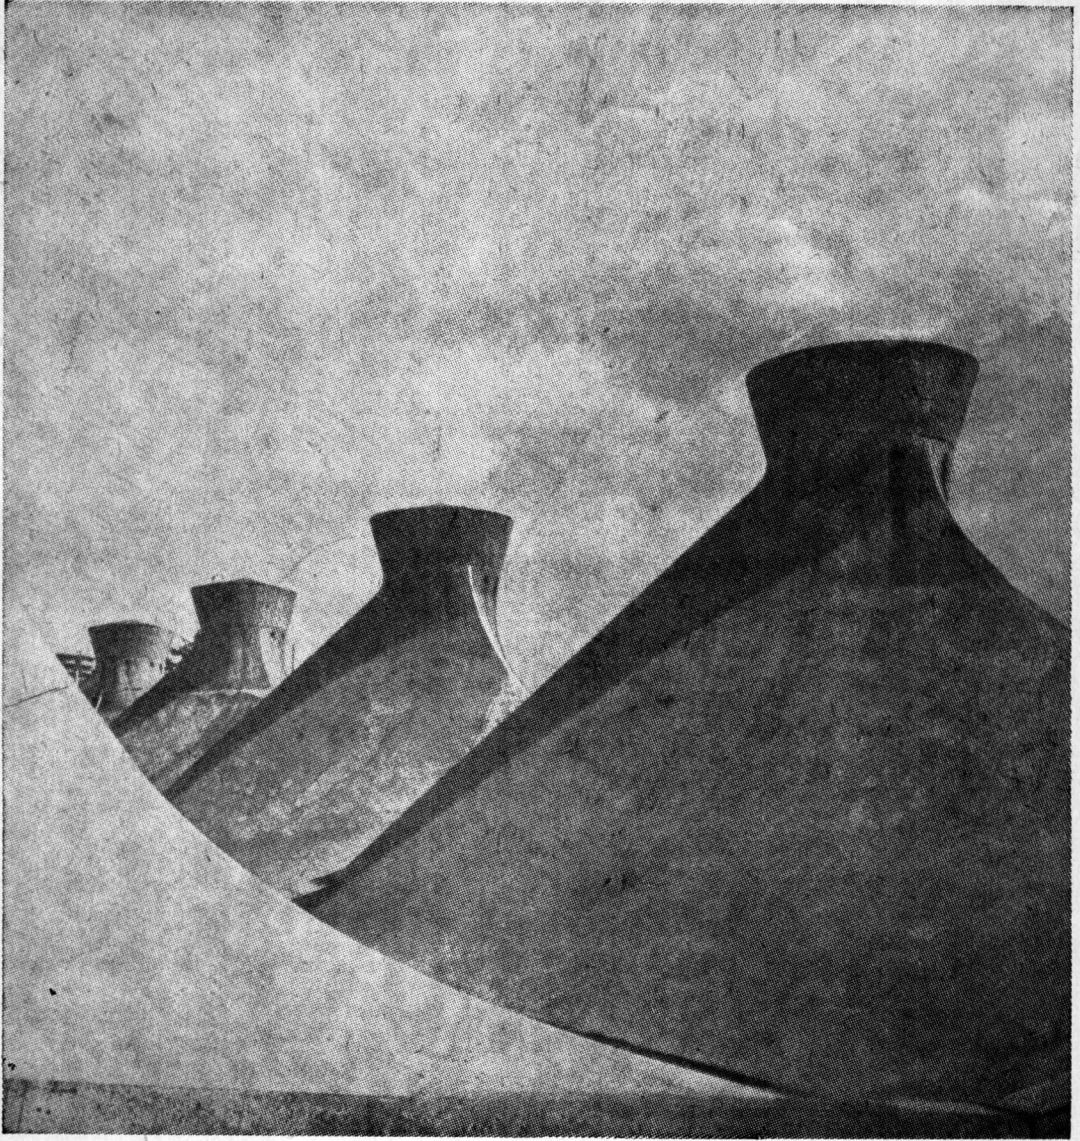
德国美因河畔洛尔的一个铸造厂的钢筋混凝土屋面[131]
